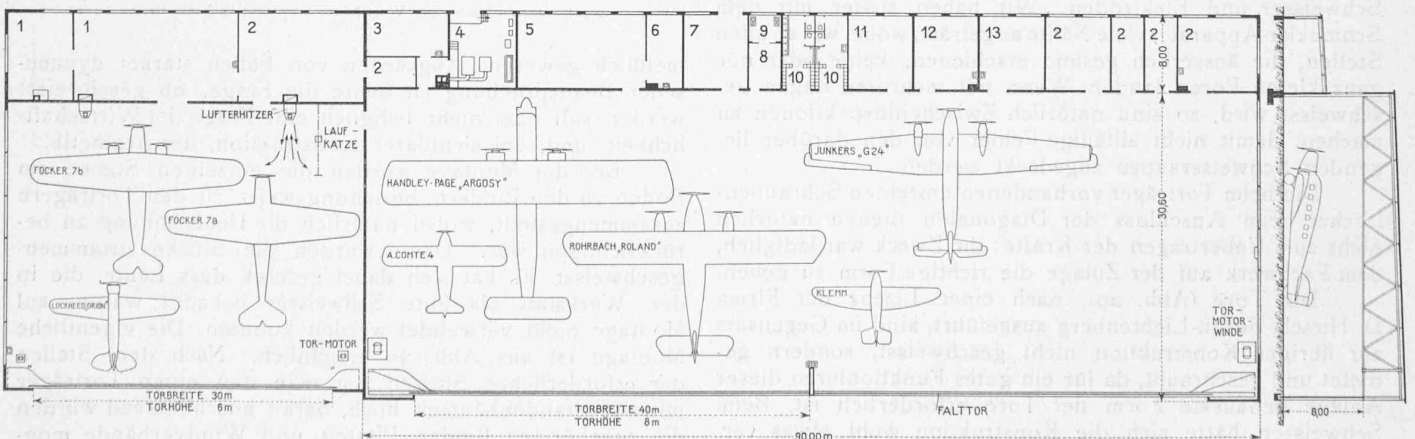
Grundriss von Werft und Hangar mit ihren Werkstatt-Anbauten, und Schnitt Hangar 1 : 700. — Legende: 1 Allgemeine Werkstatt, 2 Magazin, 3 Technisches Bureau, 4 Heizung, 5 Motorenwerkstatt, 6 Waschraum, 7 Oellager, 8 Schaltraum, 9 Benzinpumpen, 10 Garderoben, 11 Aufenthaltsraum, 12 Sattler und Maler, 13 Schreiner.
